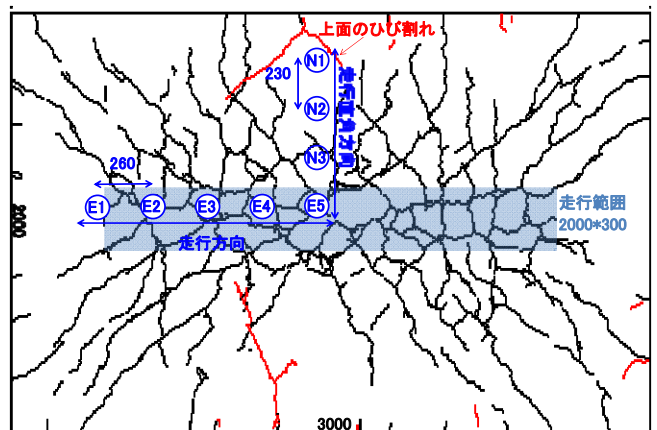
輪荷重走行試験終了時のひび割れ状況
